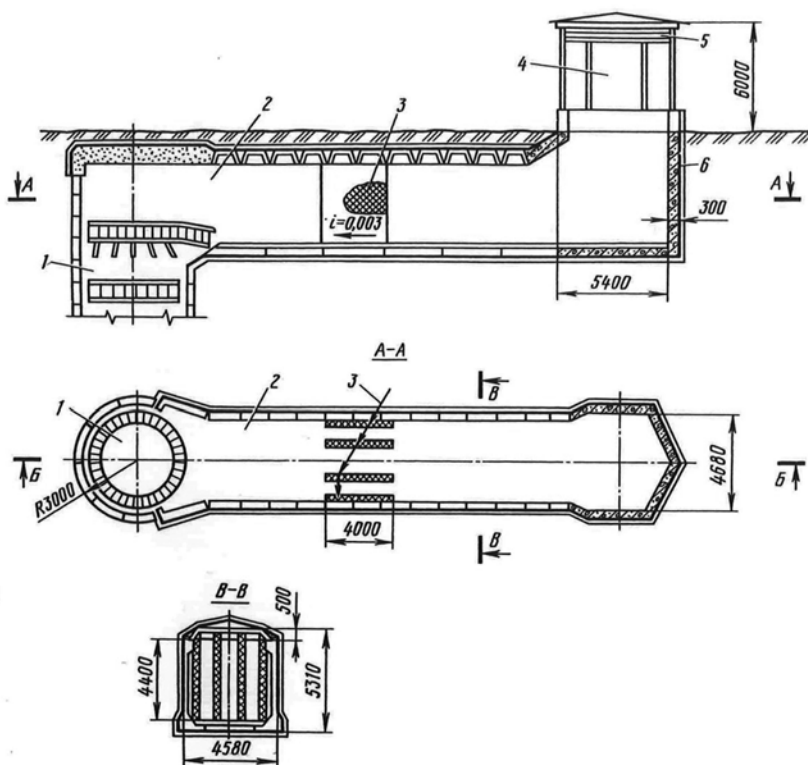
Верхний вентиляционный узел: 1, 2 – соответственно вентиляционная шахта и канал; 3 – шумопоглощающие стены из специальных блоков; 4 – вентиляционный киоск ТНП-1; 5 – монорельс; 6 – гидроизоляция
